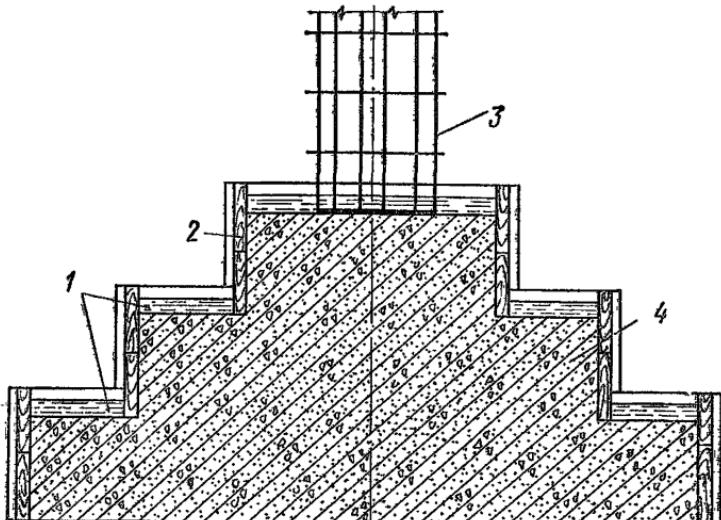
Опалубка для бетонирования фундаментов под колонны
